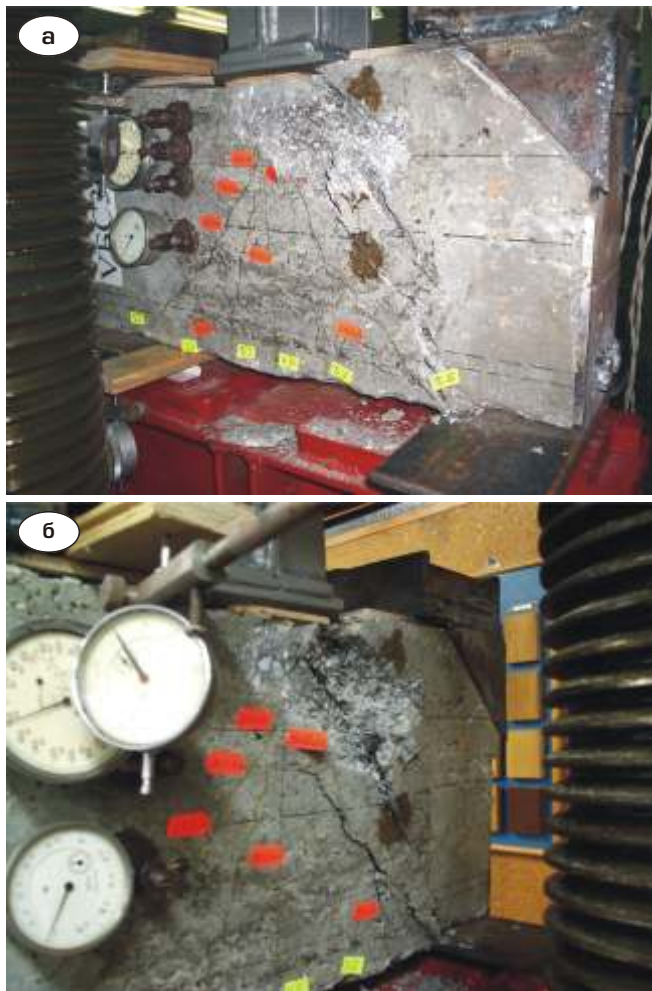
Одновременное разрушение опытной составной конструкции балки-стенки ВБС30-40 пятой серии от среза: а – трещина, идущая сверху от силы; б – от раздавливания бетона
